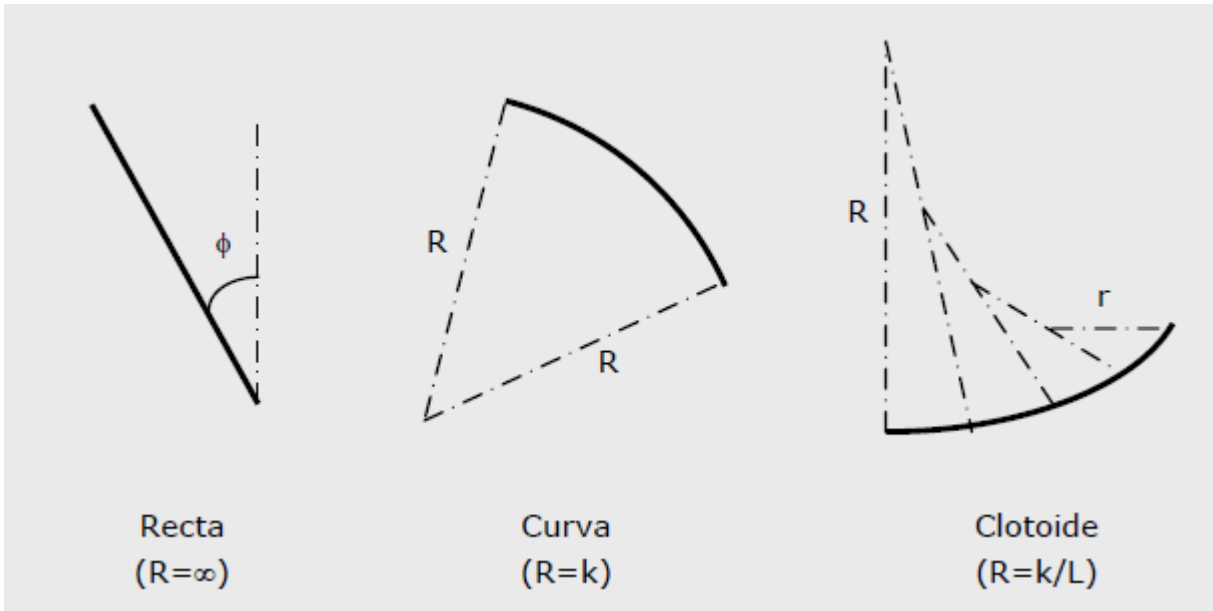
Tipos de alineaciones en planta. (Bañón; 2000: sección 10.4)
